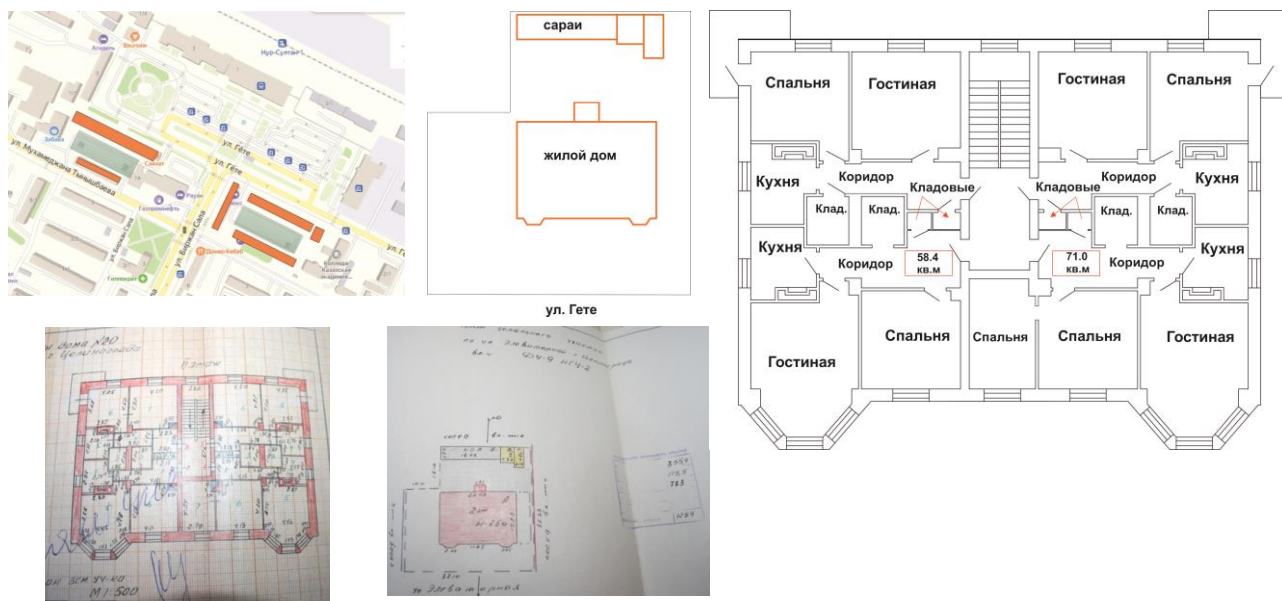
План участка и план типового этажа жилого дома по ул. Гете 20 (материалы автора).
